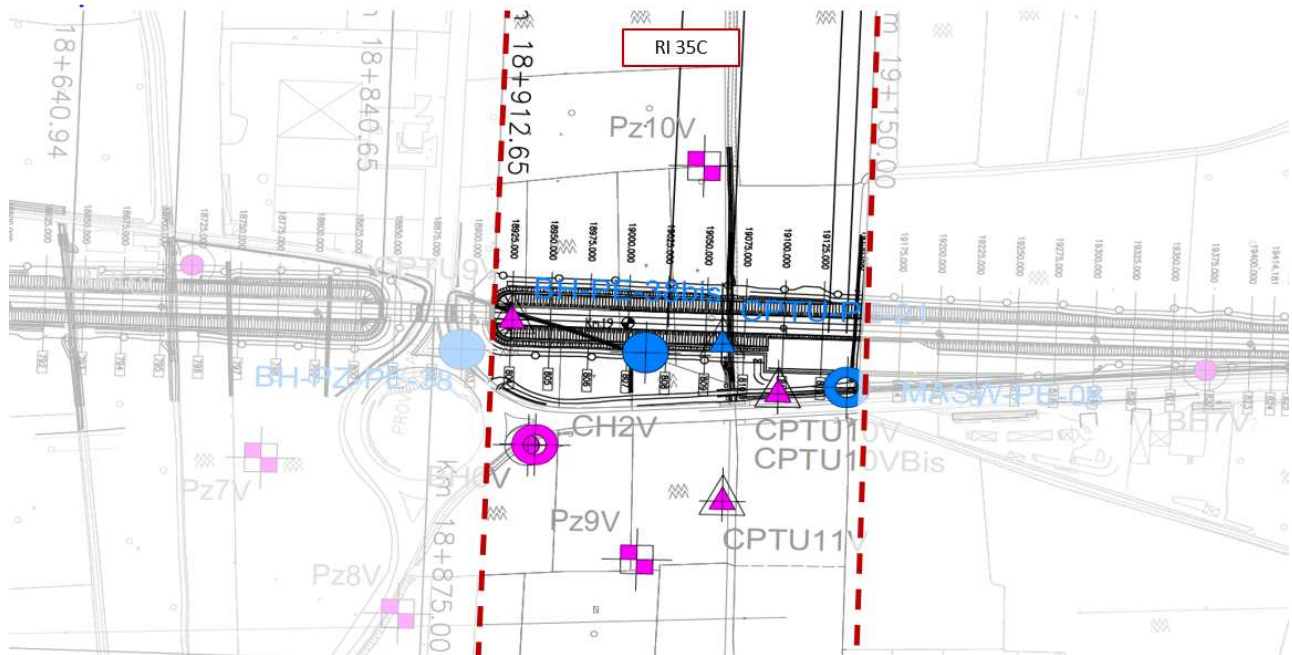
Planimetria Rilevato RI35C, estratto dalla Planimetria Generale (Doc. Rif. [3])
